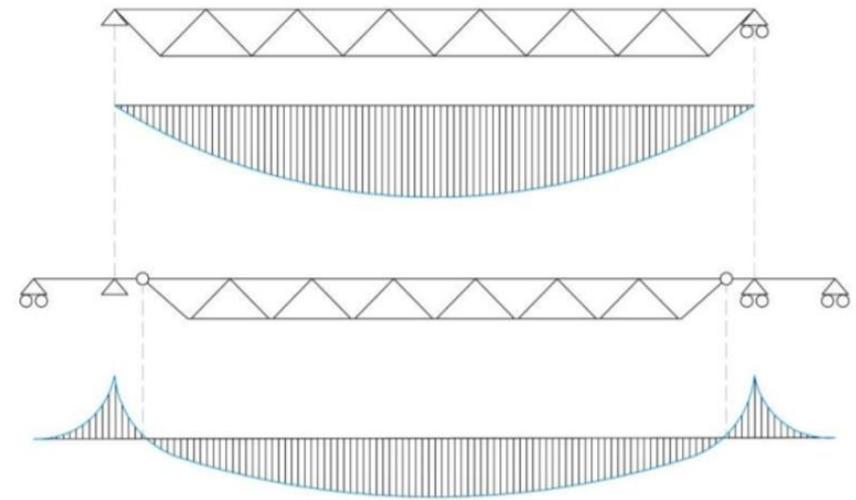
Comparación viga Gerber con viga articulada en los pilares. Ana Ezquerro Eguizábal.
